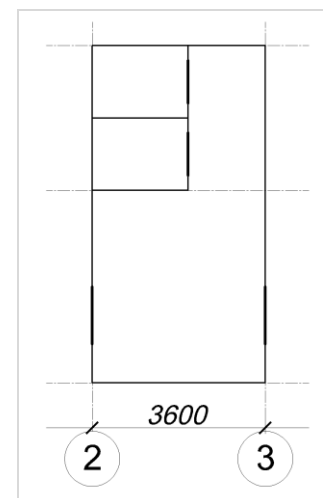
Отверстия в стене (фрагмент плана)
